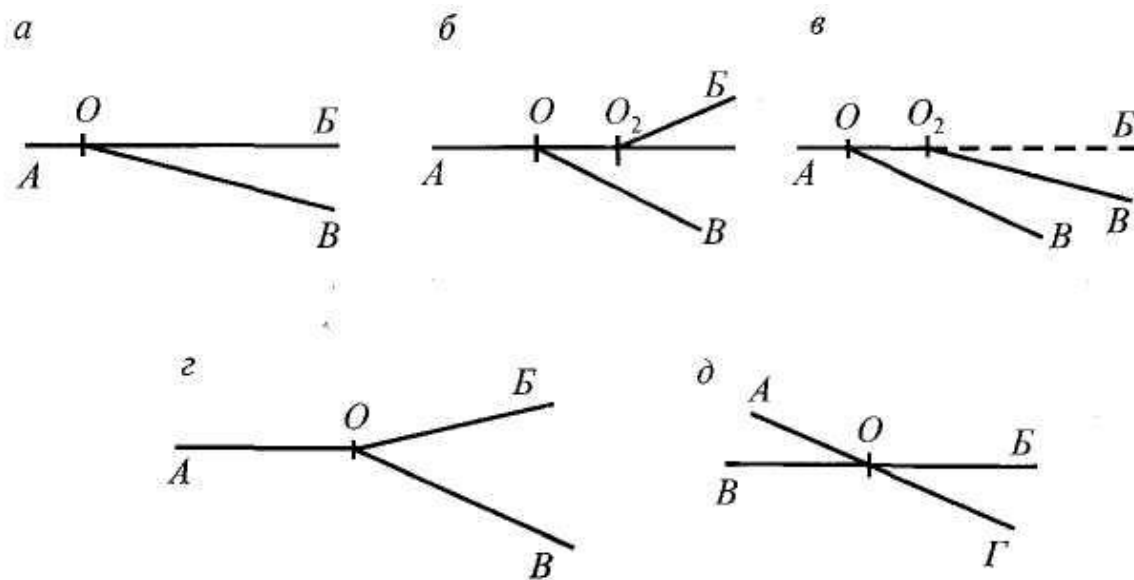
Условные обозначения стрелочных переводов на планах:
